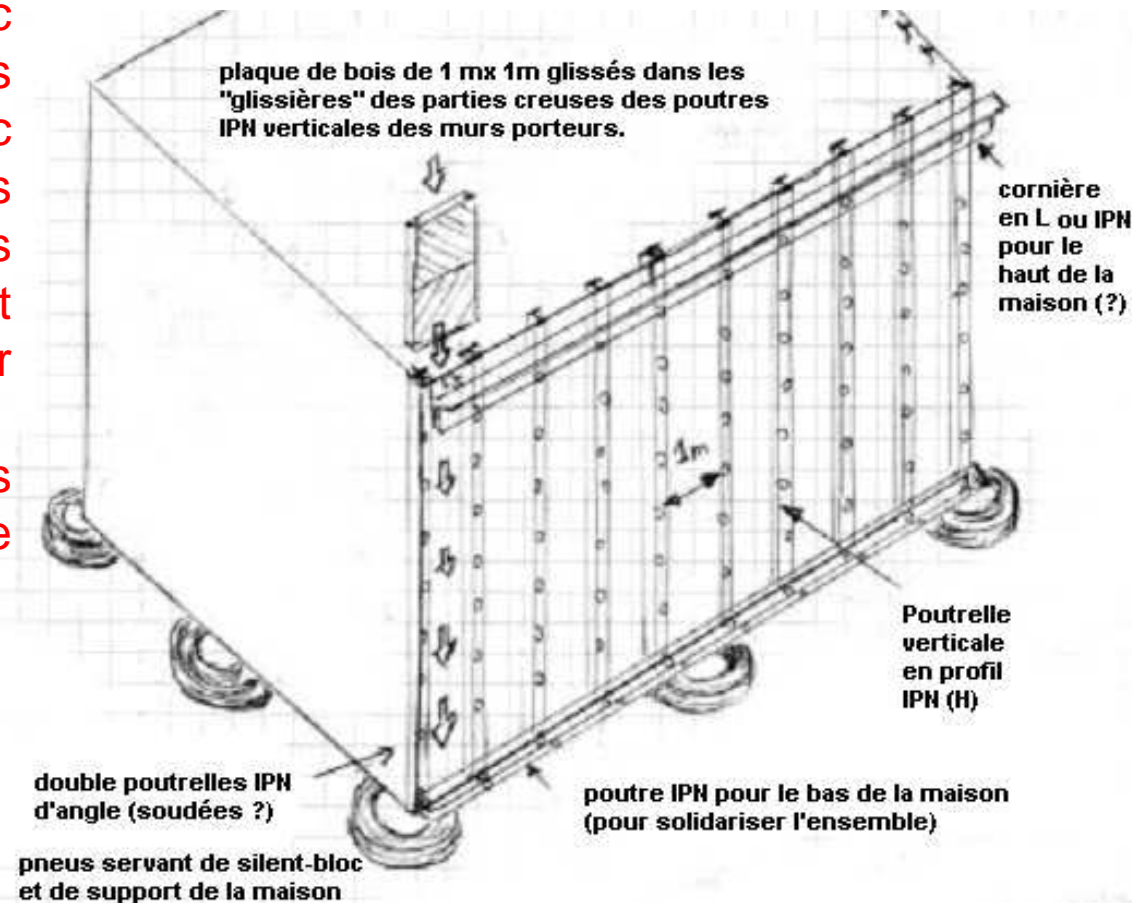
Glissement des plaques verticales entre les poutres verticales de la variante 2.
